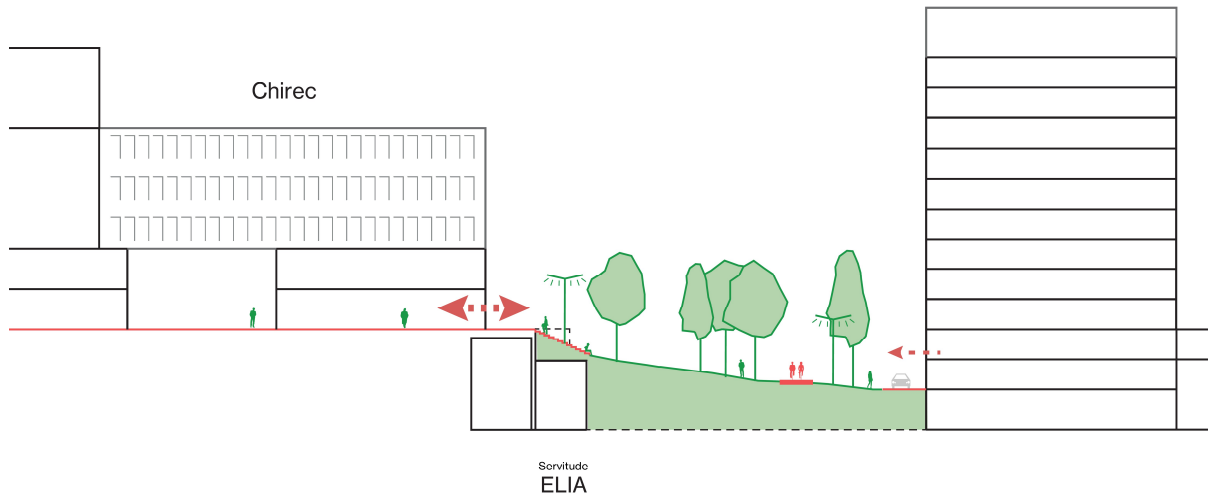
Vue en coupe du parkway sur le site Triangle (ORG, 2018)
